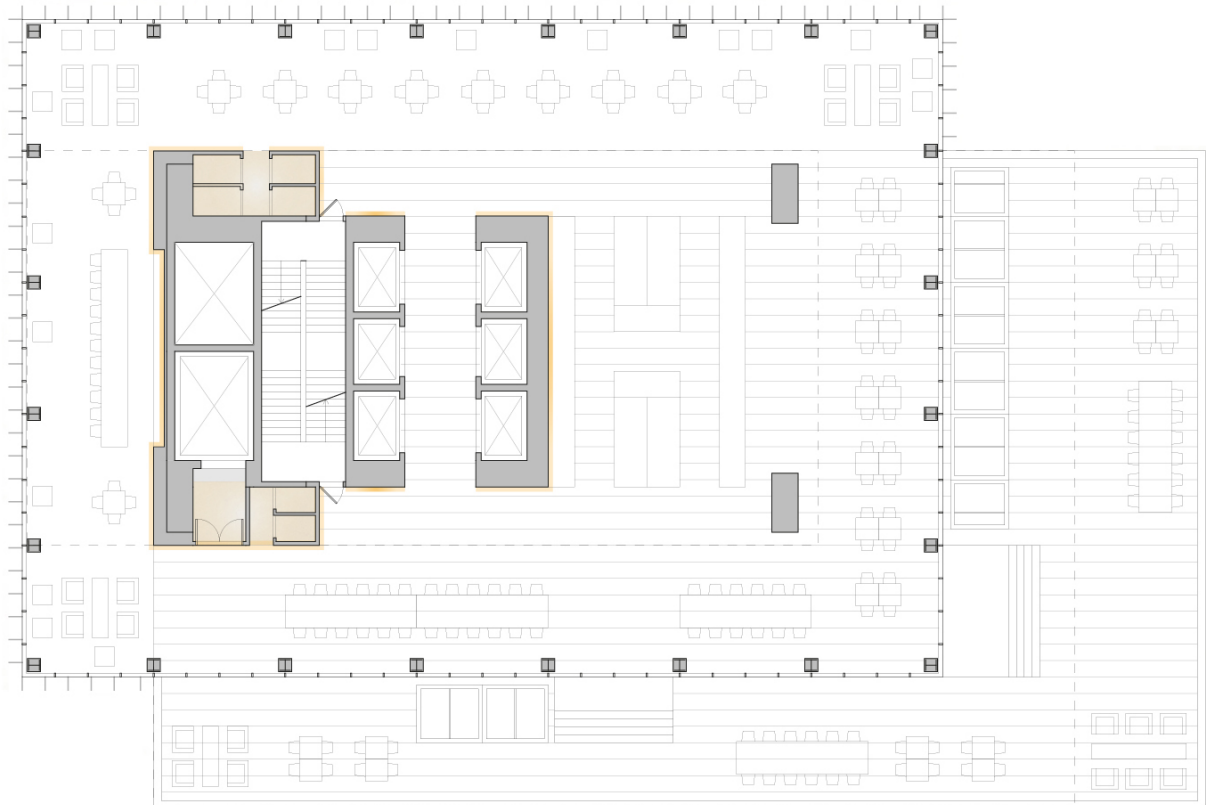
Plan d'étage du niveau 21, illustration de l'auteur
